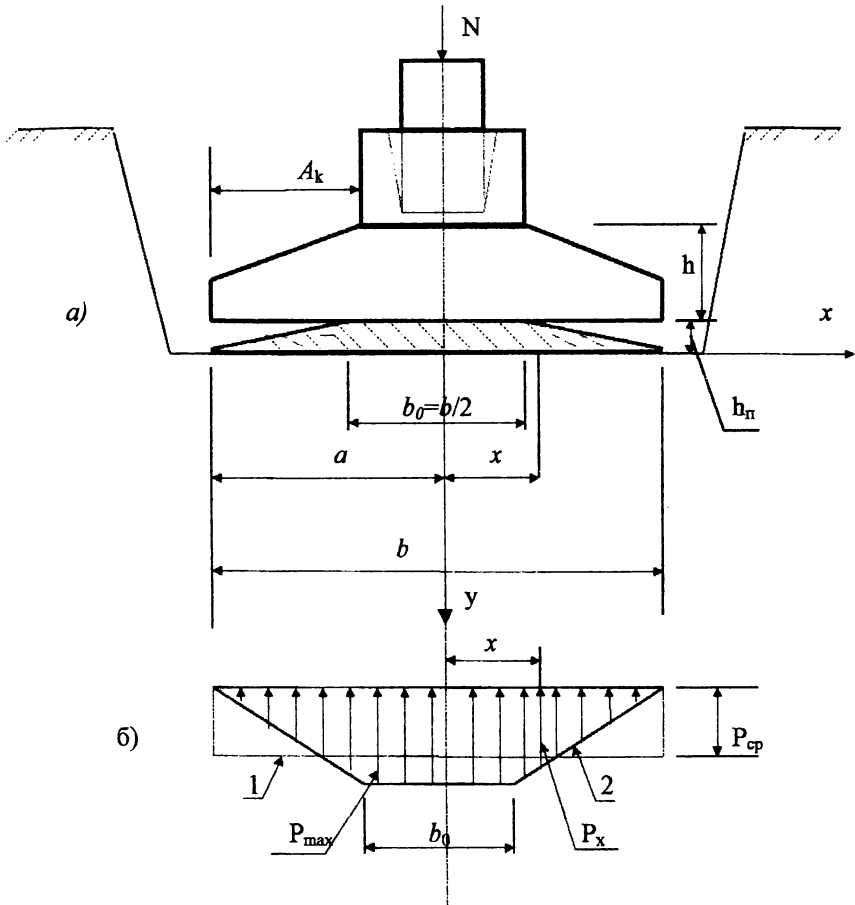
Схема основания с песчаной подушкой в виде усеченной пирамиды для фундамента под колонну:
